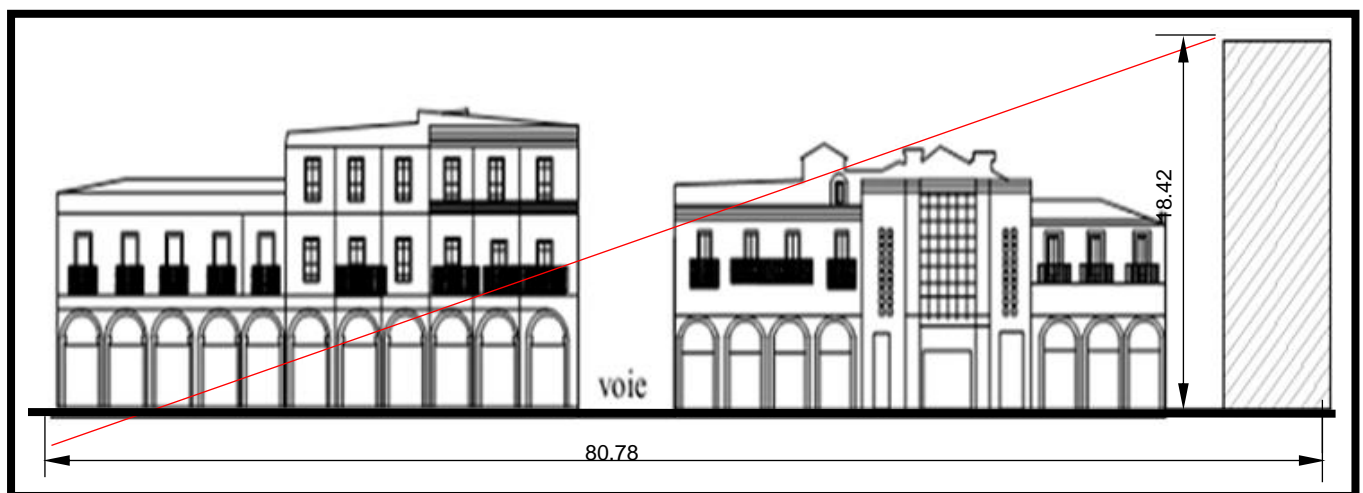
,3 : Coupe montre le rapport entre la hauteur de l'édifice à droite et l'éloignement.
